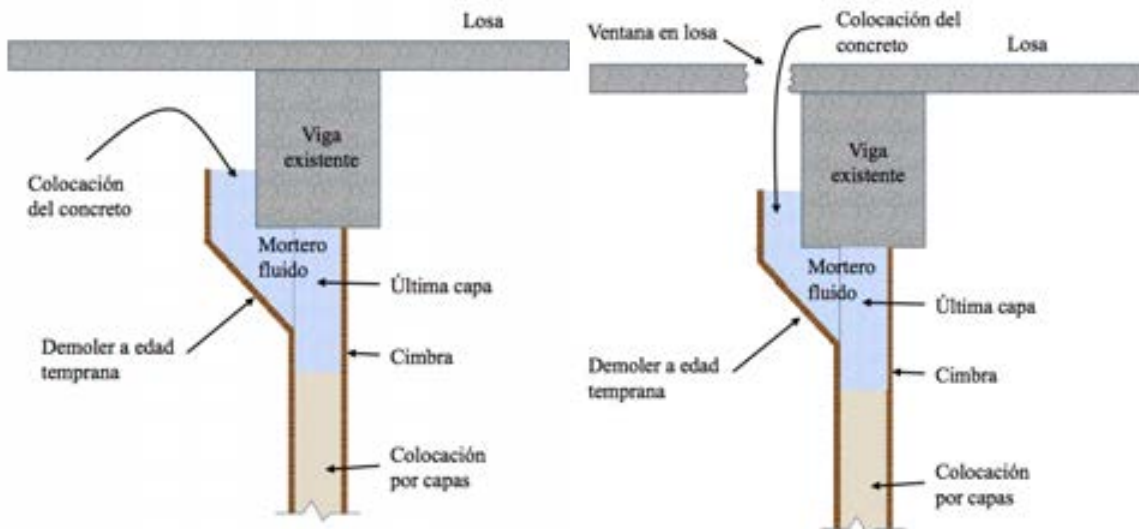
Colocación de concreto de muros diafragma, (Terán A., 2009)
